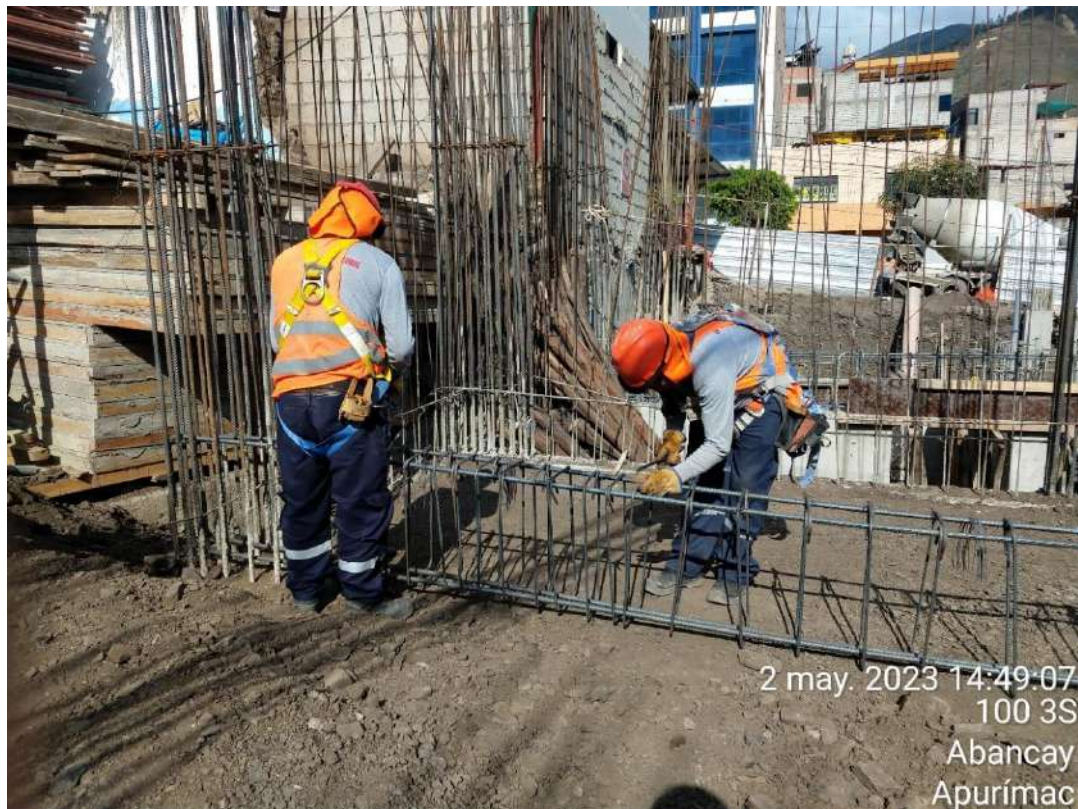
Armado de acero de refuerzo en vigas de cimentación
